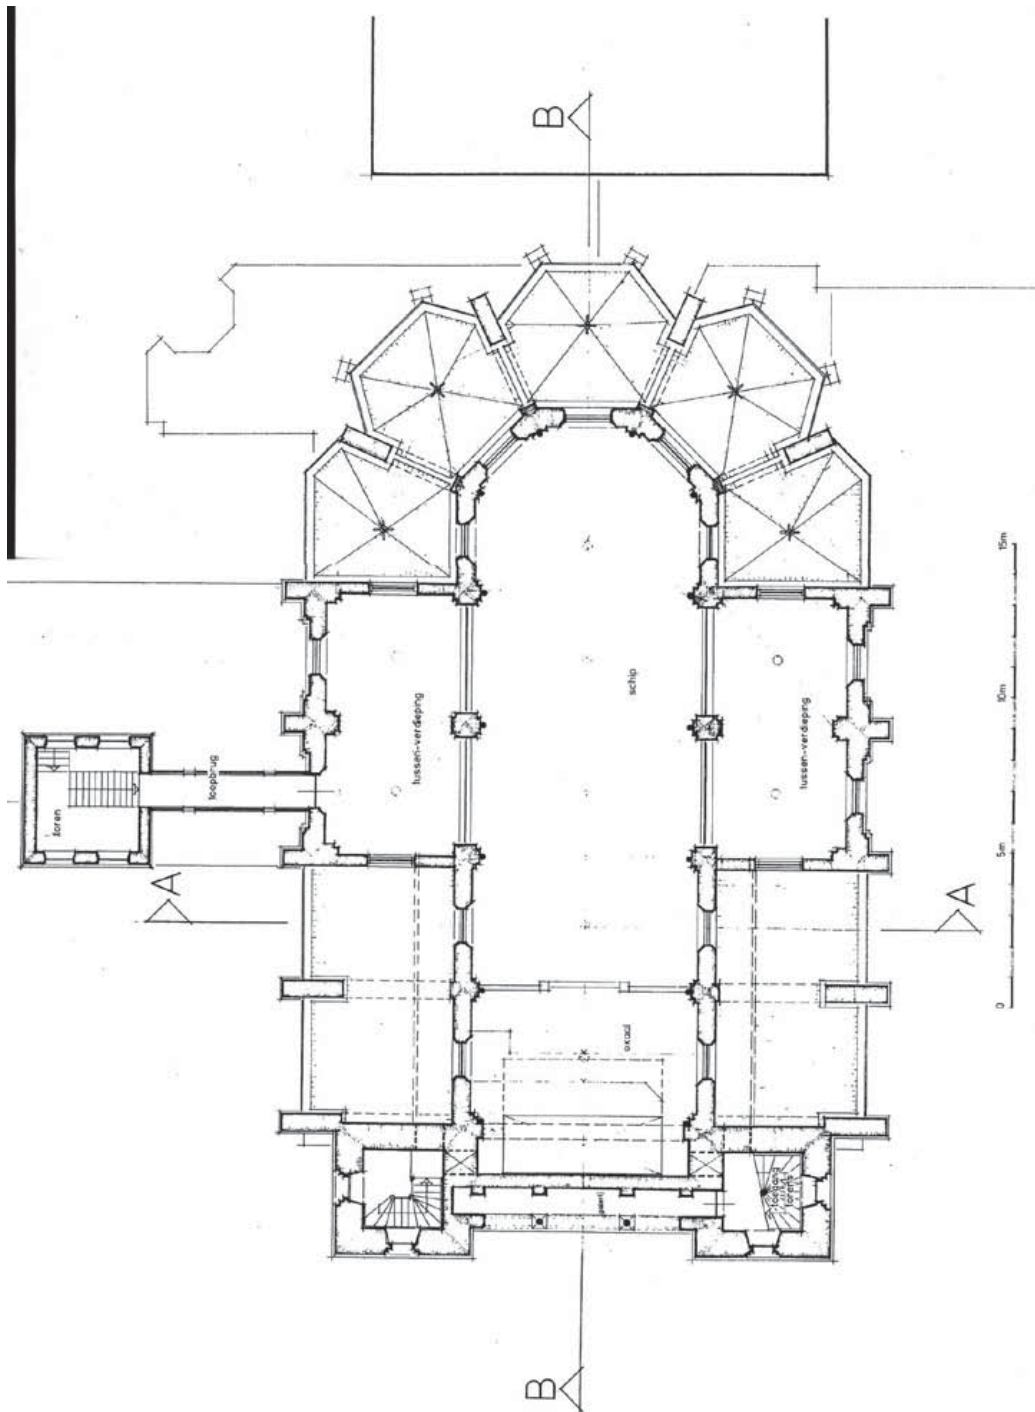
Grundriss Zwischengeschoss, aufgenommen 1995 (Maßstab im Originalplan 1:100)
